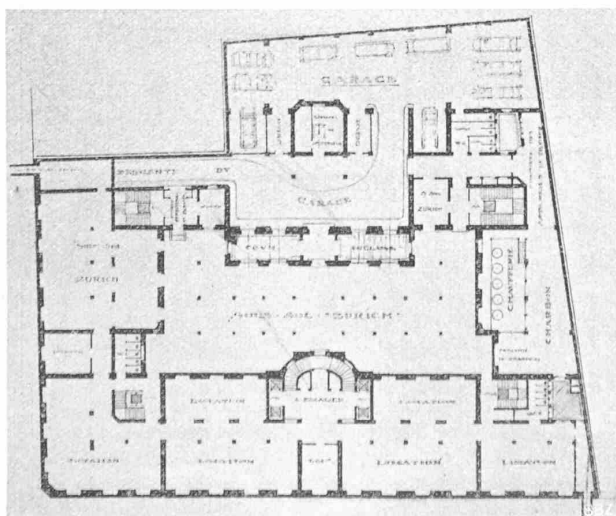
Untergeschoss-Grundriss 1:800. — Entwurf von Arch. Patouillard, Paris. — Abb. 10. Erdgeschoss-Grundriss 1:800.
